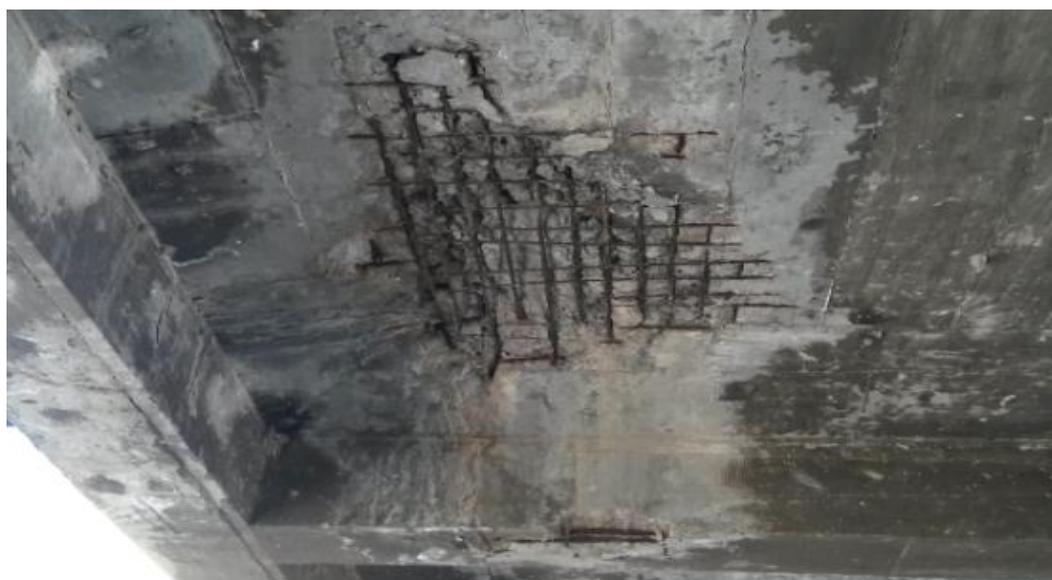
Desagregação do concreto e corrosão de armadura da ponte AL 220.
